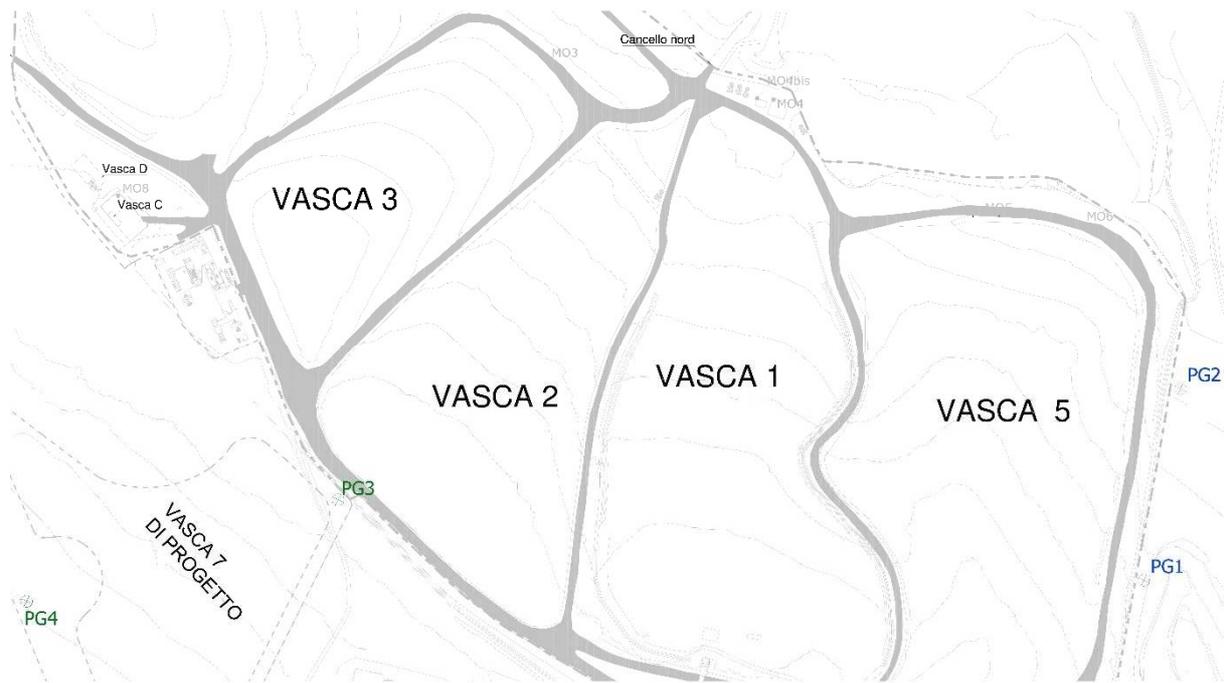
Stralcio planimetrico dei punti di monitoraggio fughe di gas dal suolo
